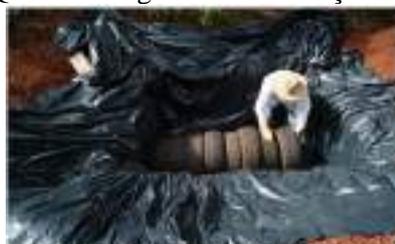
Figura A – Escavação, impermeabilização com lona plástica e tubulação com pneus usados;
